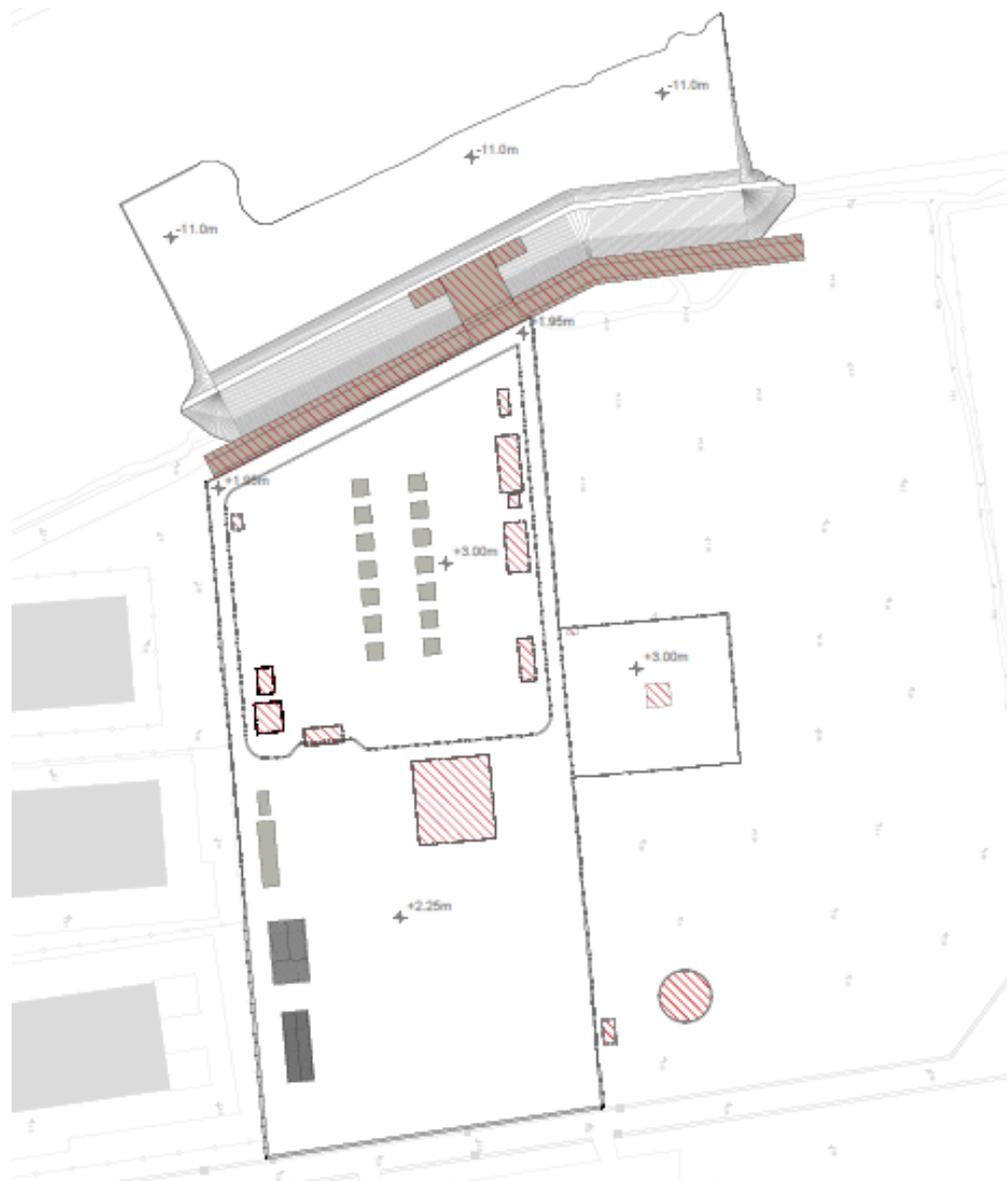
Fase 4 aree oggetto di lavorazioni
